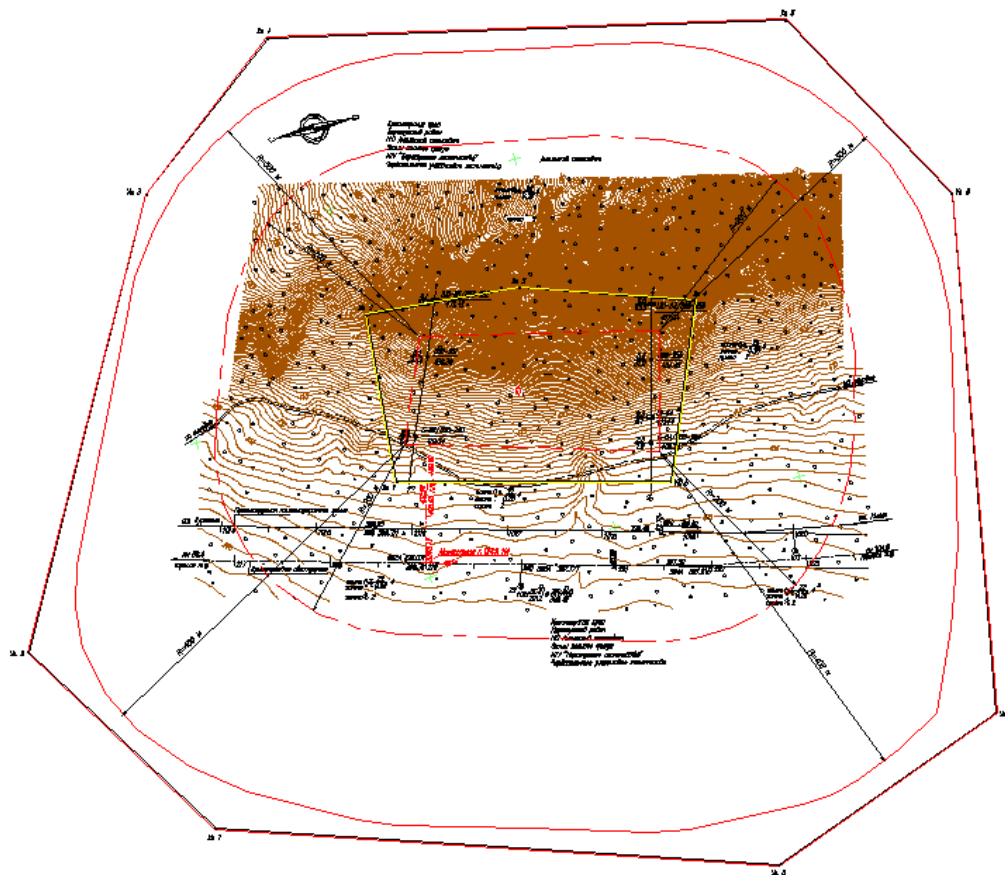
Пример размещения вскрышных отвалов, склада для просушки грунта и прочих карьерных объектов при разработке площадки грунтовых строительных материалов, сложенной обводненным галечниковым грунтом
